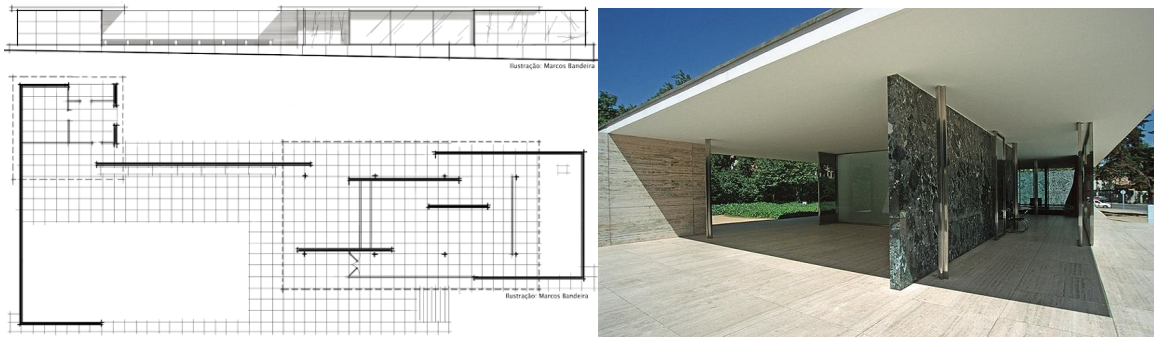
Pavilhão Alemão - Mies Van der Rohe - 1929 Barcelona e reconstruído em 1980 - Espanha
